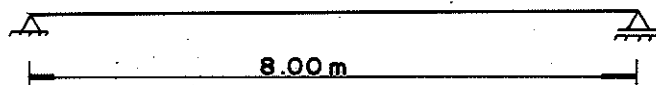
ESQUEMA ESTÁTICO DA VIGA PRINCIPAL
